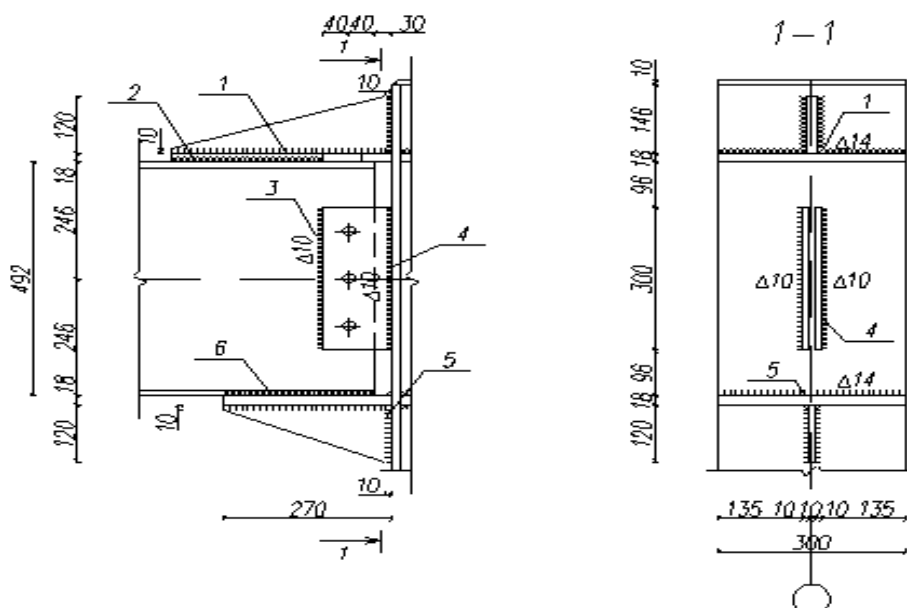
Вузол 1: Кріплення ригеля до колони виконуємо на зварюванні з допомогою пластин.
